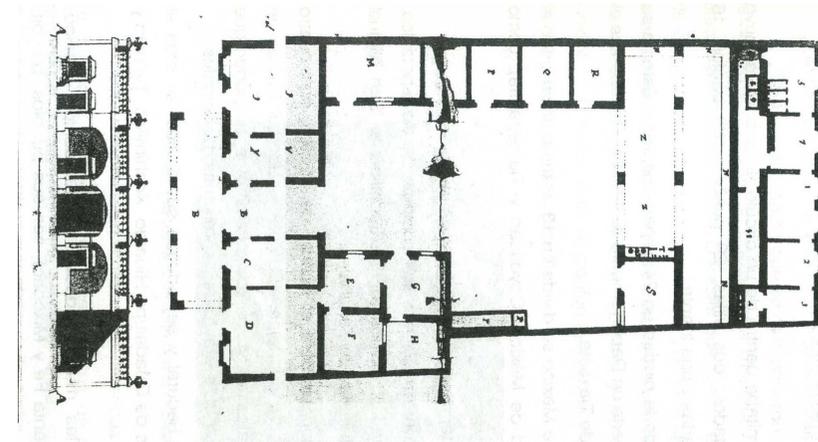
Planta y alzado de una casa en la villa de Tacubaya, año 1745.
